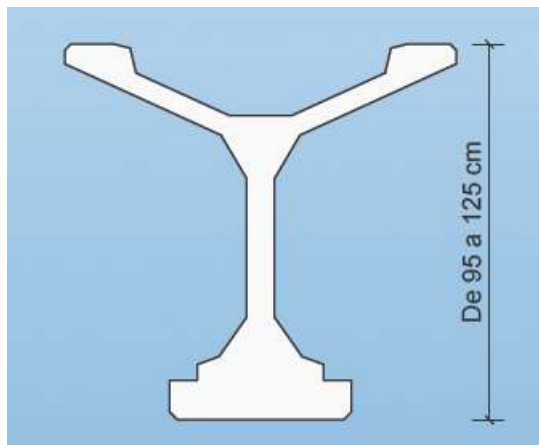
Viga do Tipo “ITALVAN” [15]
